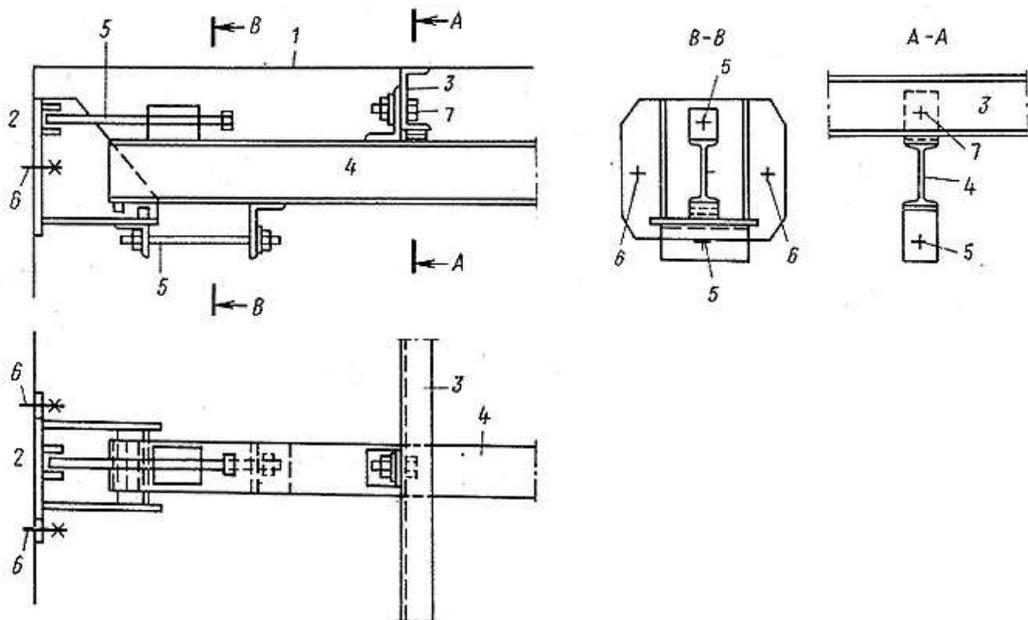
Усиление балочного перекрытия с помощью буксы:
